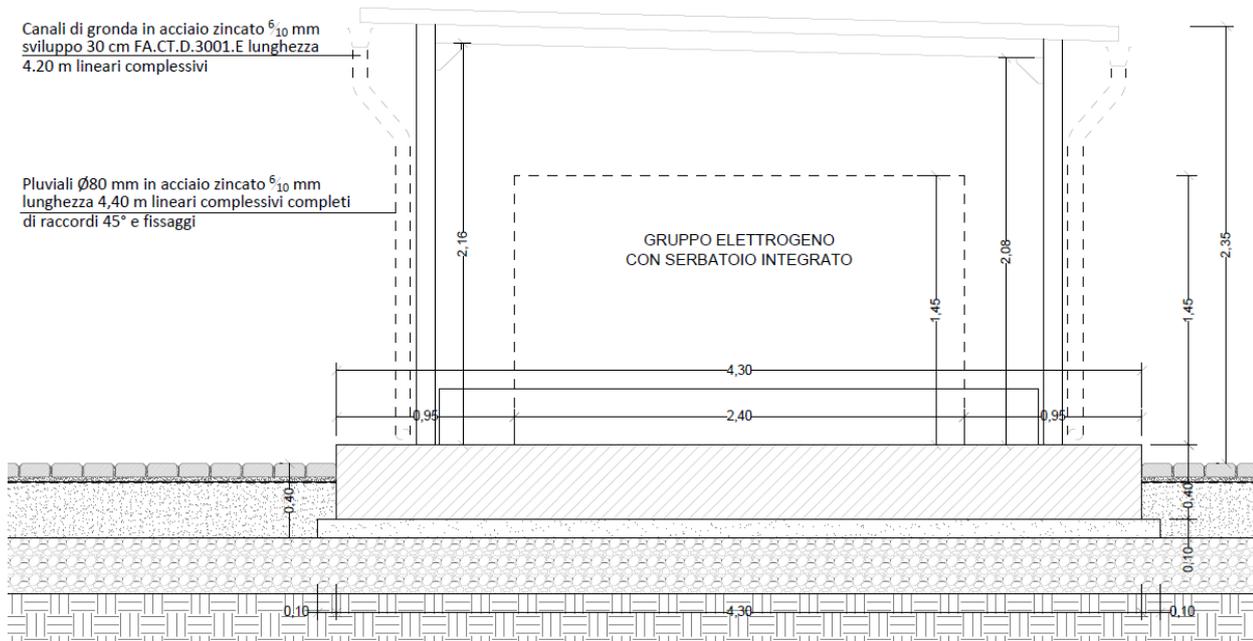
FA02 - Sezione basamento GE con tettoia metallica
